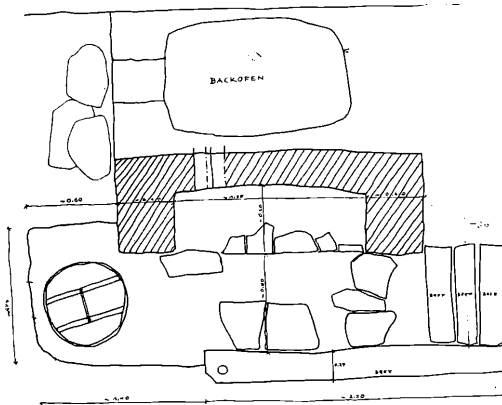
Grundriss der rekonstruierten Feuerstelle beim Taxbauern.
